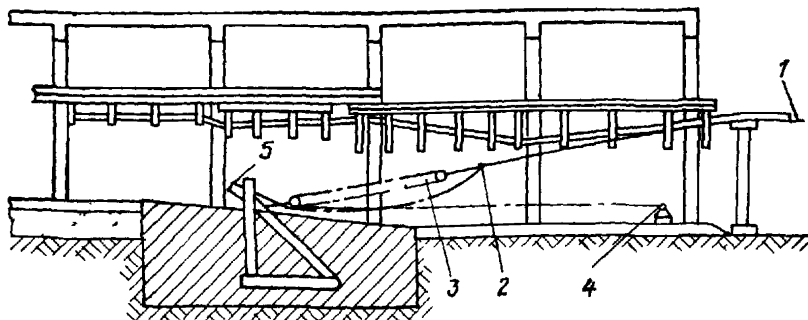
Натяжка несущего каната в сторону анкерного устройства:
